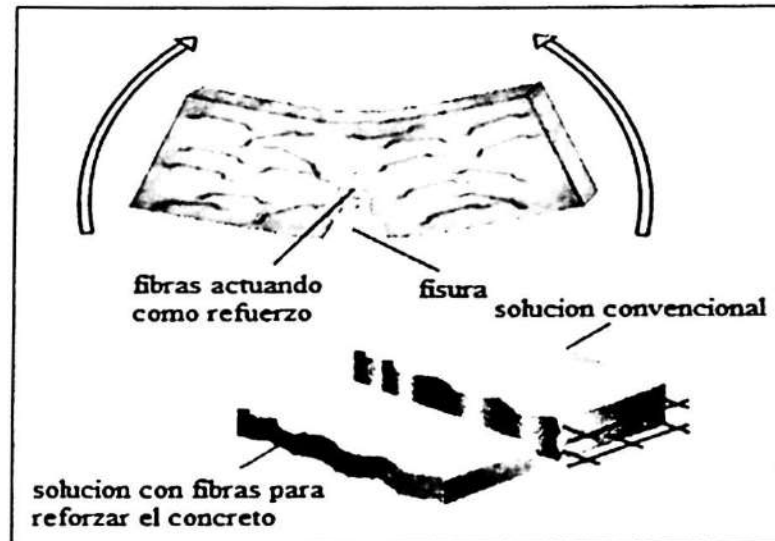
Las fibras se oponen al desarrollo de la fisura debido a la trabazón que forman dentro de la matriz de concreto.
